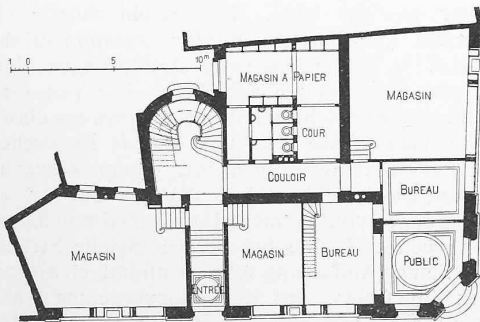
Maison Wolfrath. — Plan du rez-de-chaussée. — 1 : 400.
